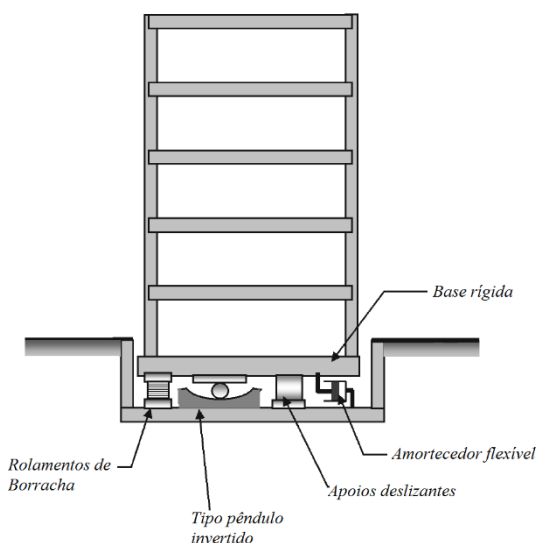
Tipos de apoios utilizados no isolamento de base (Oviedo e Duque, 2006)
